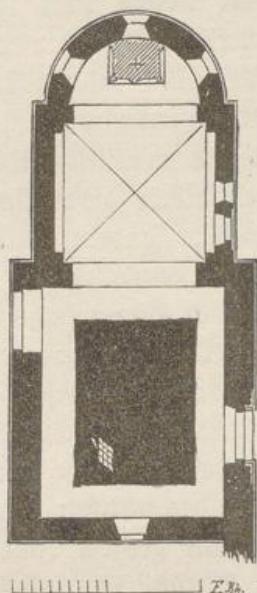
Grundriss der Melatenkapelle bei Aachen.
